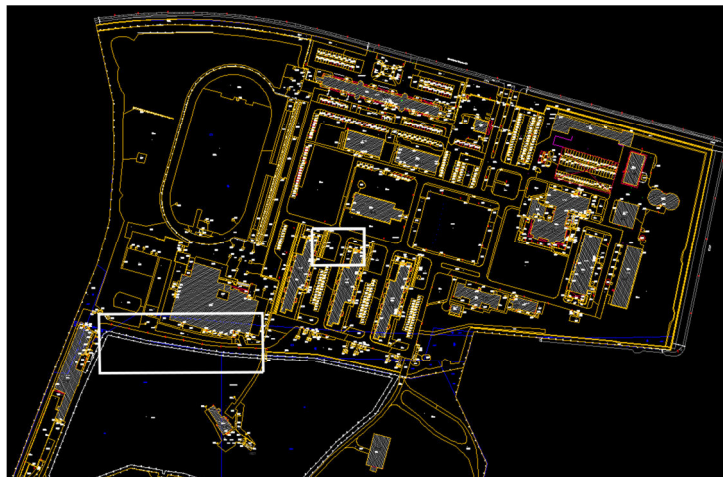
Plan Charlottenburger Chaussee, Voruntersuchung
